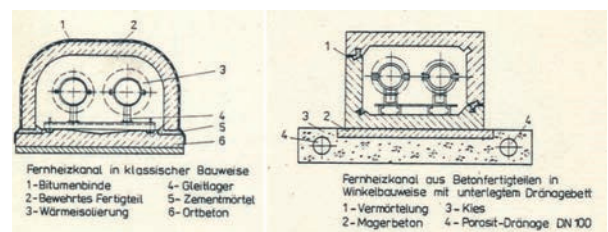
Konstruktionsprinzip klassische Bauweise (links); Betonfertigteile in Winkelbauweise (rechts) [Brachetti, 1985]
